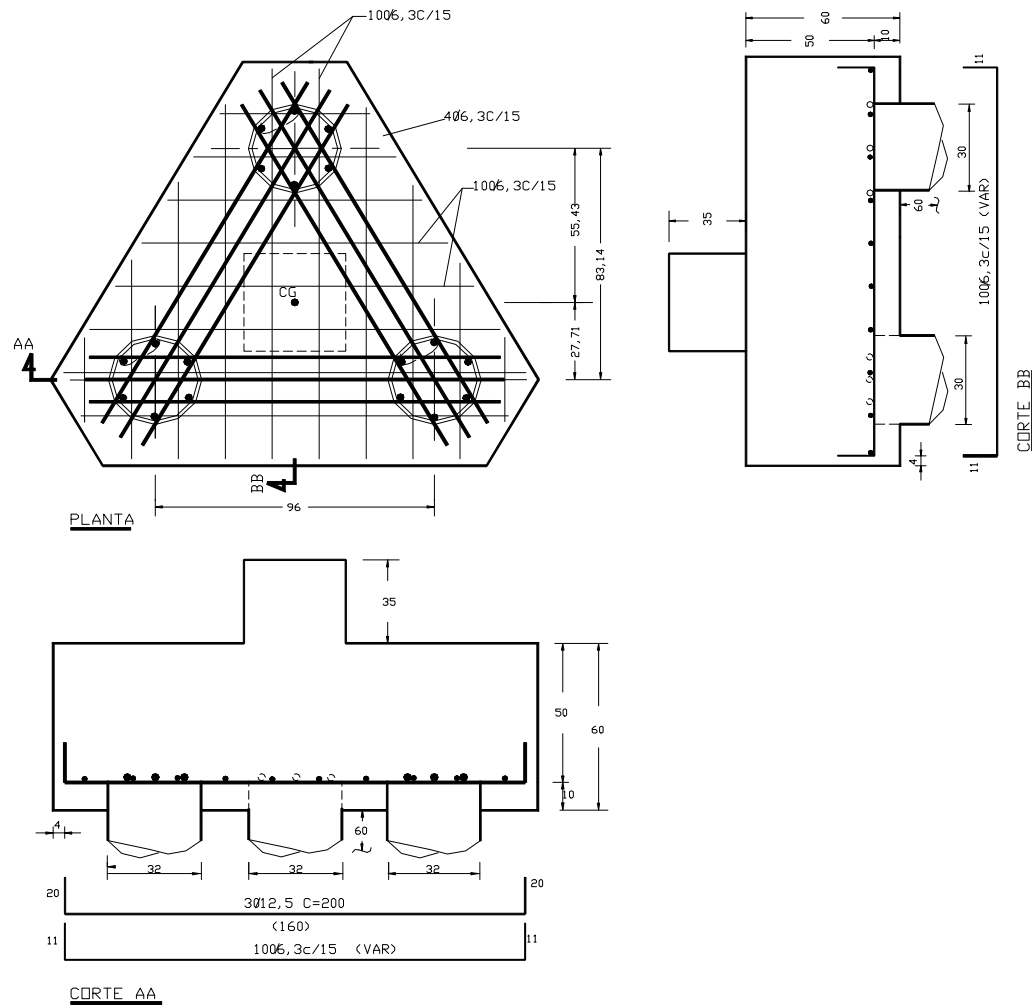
Armadura principal e armadura distribuída na base (D = 30 cm)
